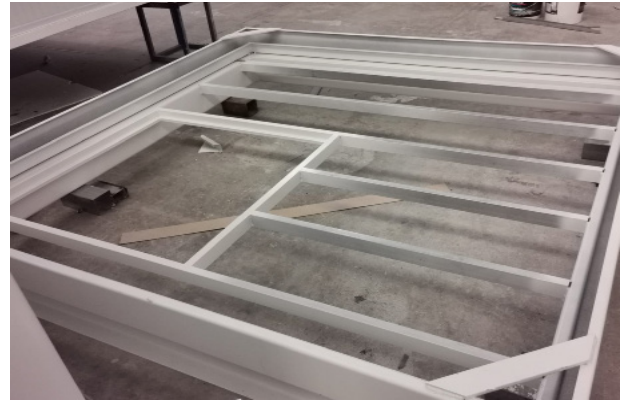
Estructura horizontal superior del módulo Cimpra adaptado para un lucernario. Fuente: Elaboración propia.
